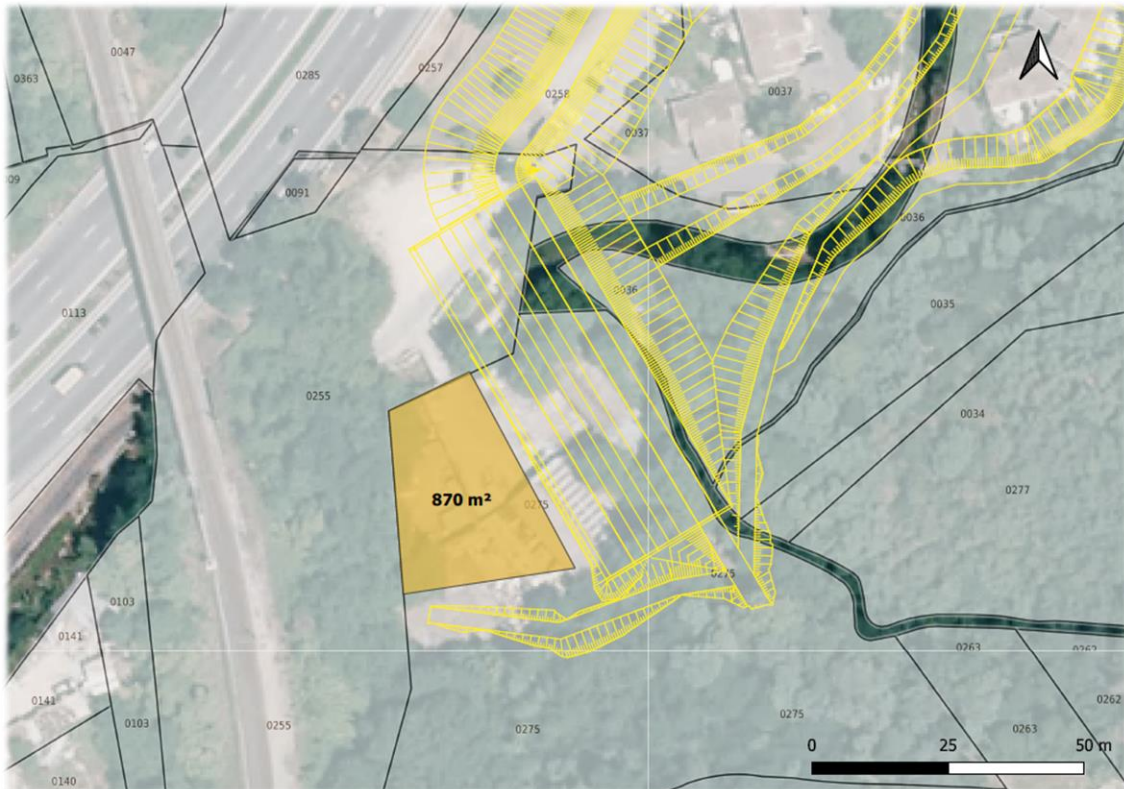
Localisation d'une zone pressentie d'installations de chantier
